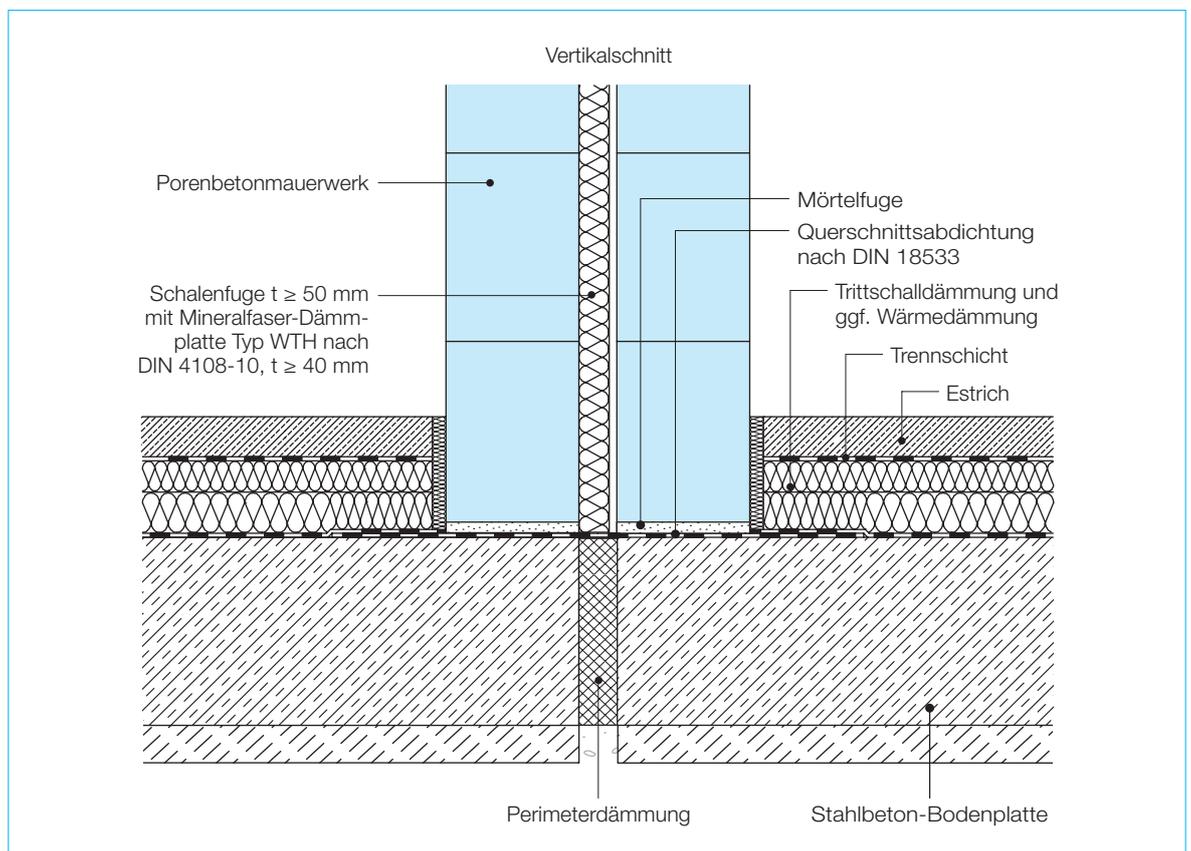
Anschluss einer zweischaligen Haustrennwand aus Porenbetonmauerwerk an eine getrennte Bodenplatte bei einem nicht unterkellerten Gebäude
